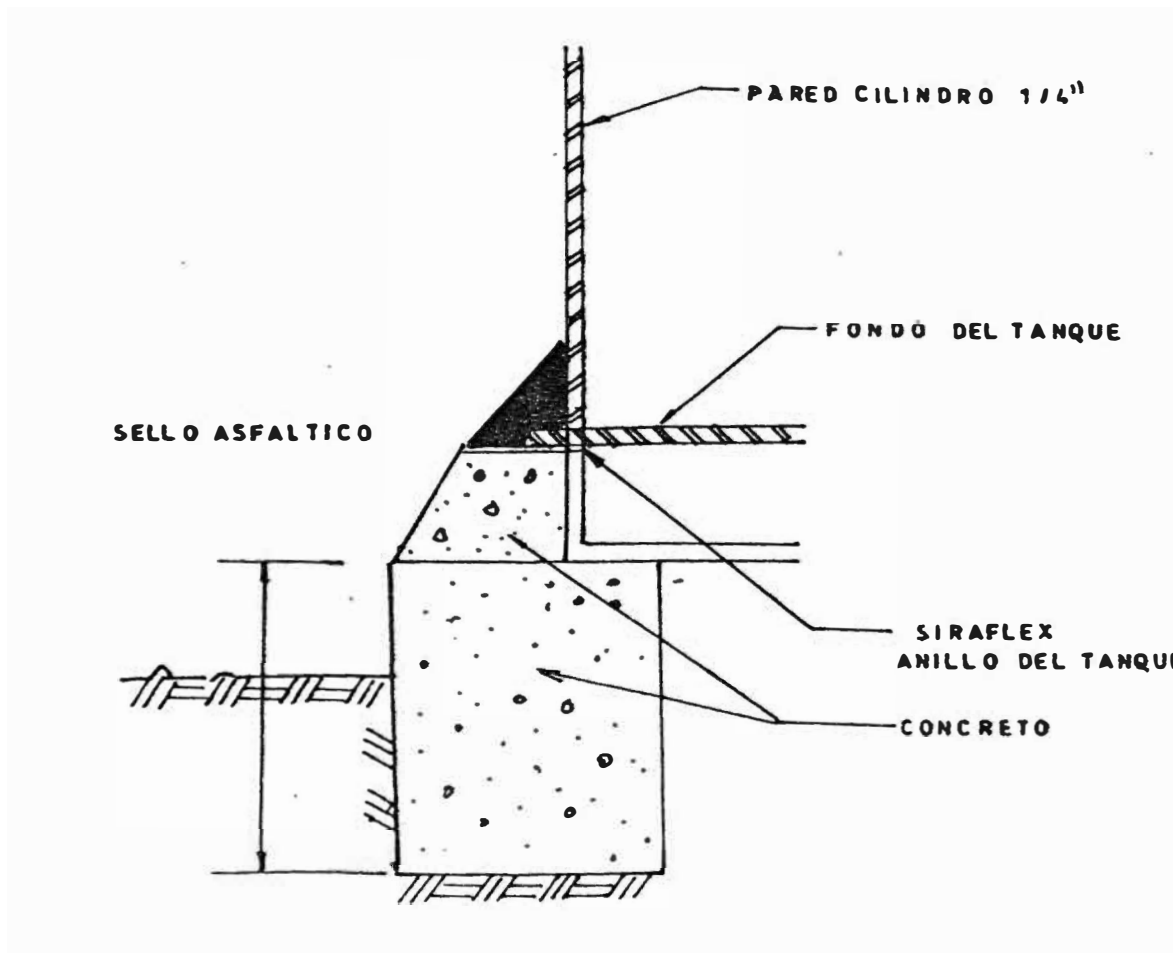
IMPERMEABILIZACION DE PESTAÑA DEL FONDO
